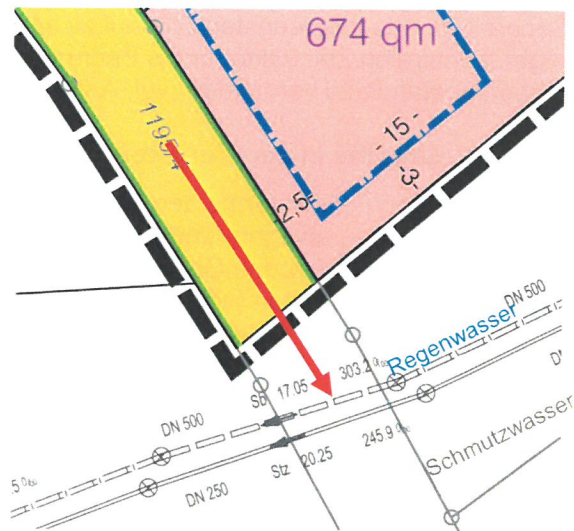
Auszug Bebauungsplan mit Flurkarte
